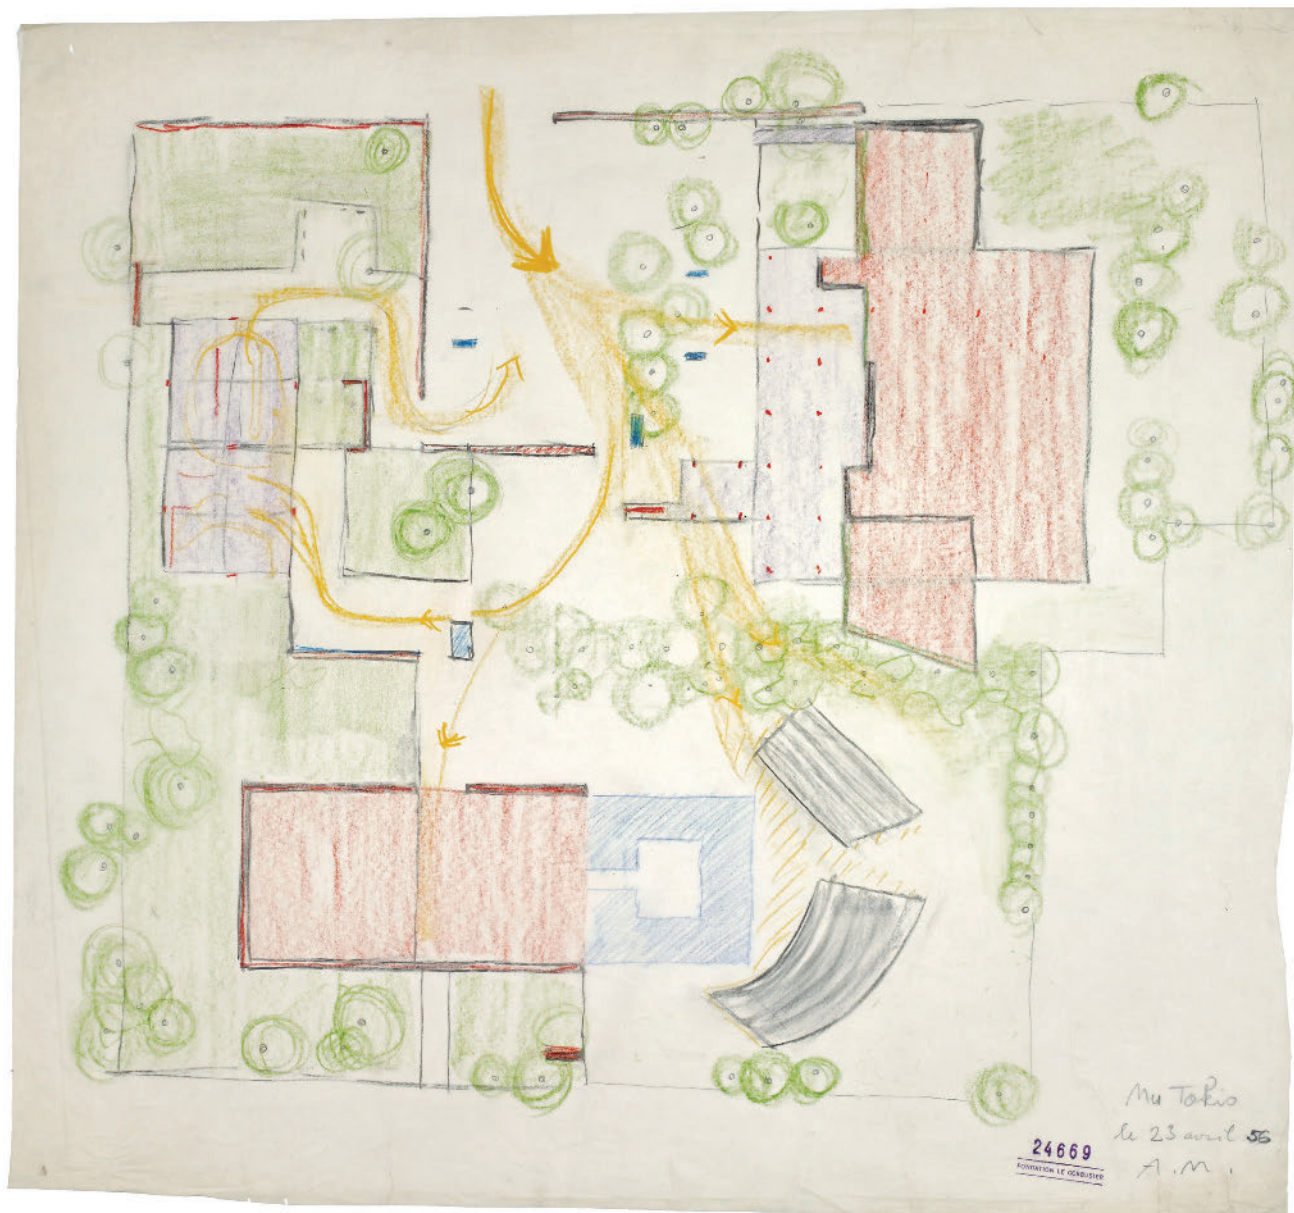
Planta do Complexo Museu de Tóquio dada de 23 de abril de 1956. Documento FLC 24669.
